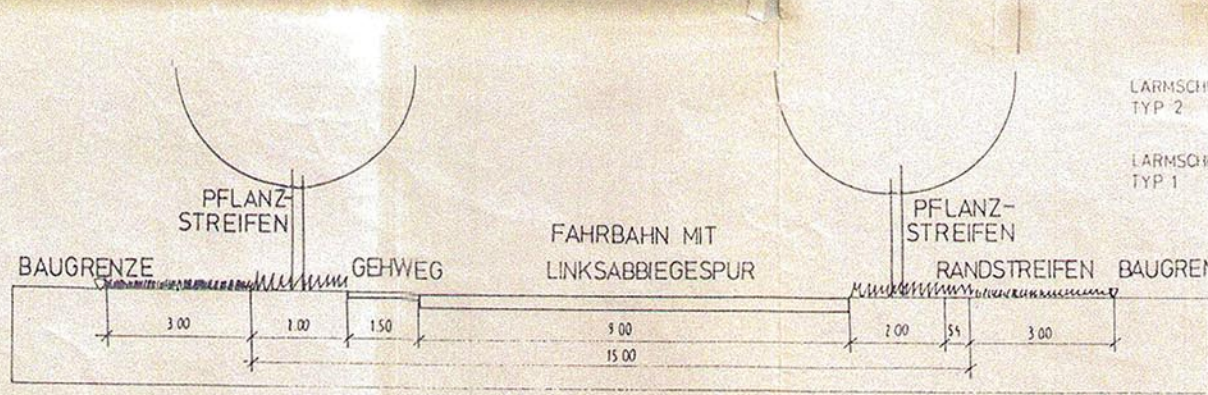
DETAIL VERKEHRSDÄMPFUNG F M: 1:200
